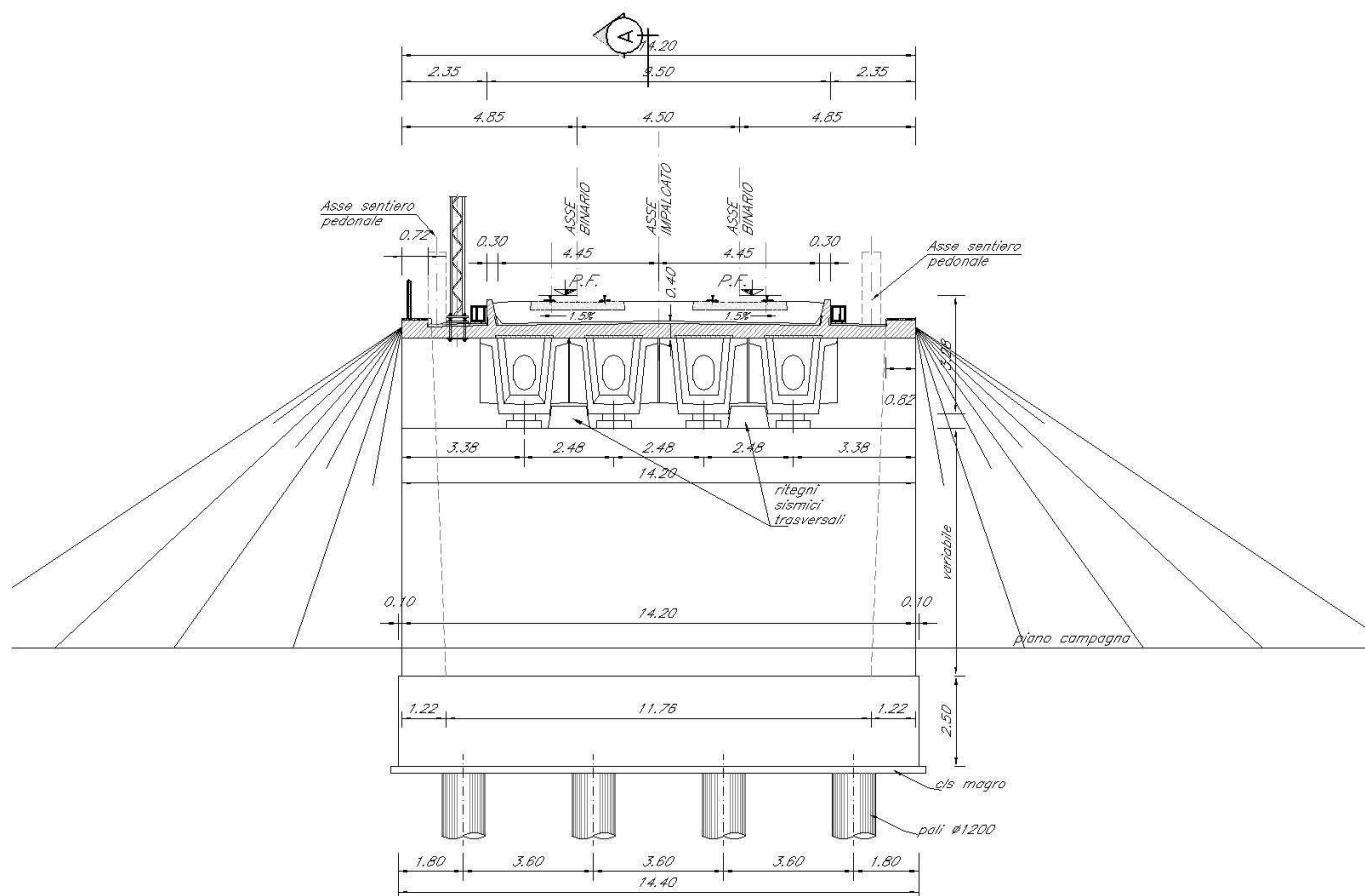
Sezione longitudinale della spalla tipo.
